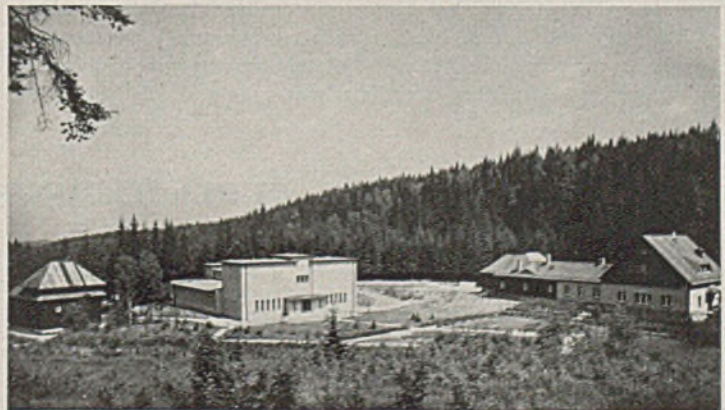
Betriebsgebäude an der Geigenbachtalsperre der Kreisstadt Plauen i. V. Links: Kalksättigungsanlage, Mitte: Neues Schnellfiltergebäude, Rechts: Zusatzanlage mit Kraftwerk und Wohnhaus.
